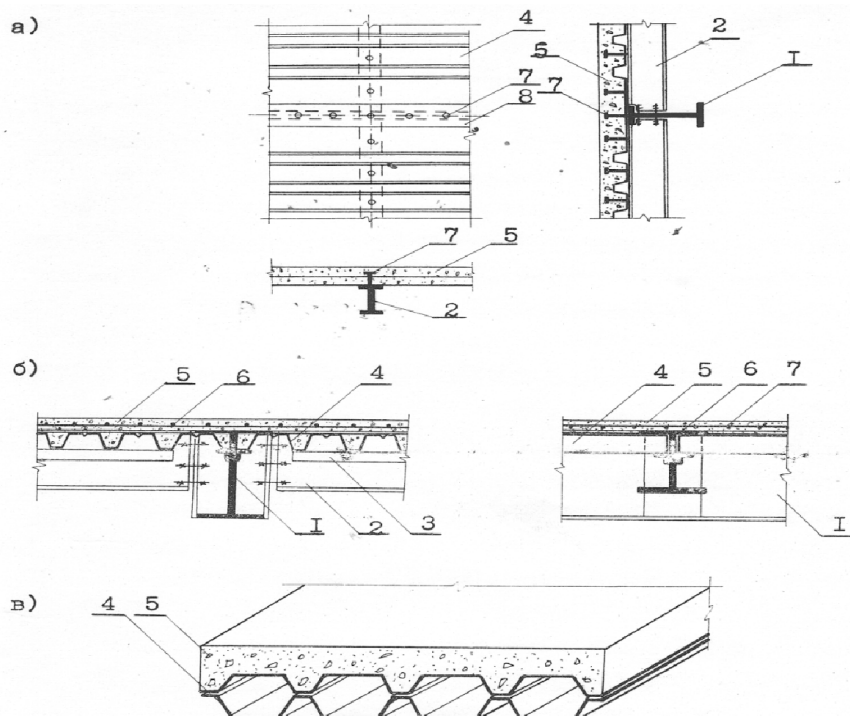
Конструкции комбинированных перекрытий, применяемых в Чехии и Польше.
